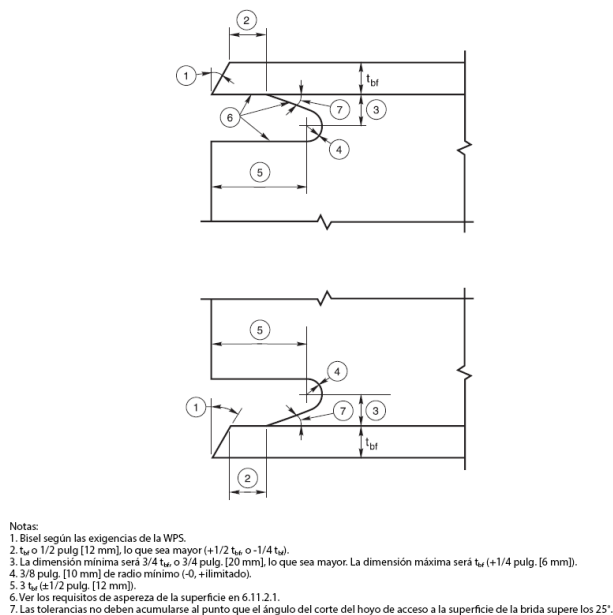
Geometría alternativa-Detalle de hoyo de acceso a la soldadura de la brida de la viga (ver 6.11.1.2)
